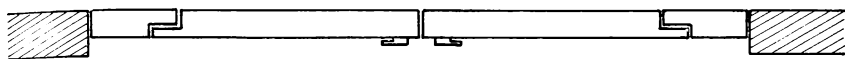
Coupe d'une porte palière battante à deux vantaux.
